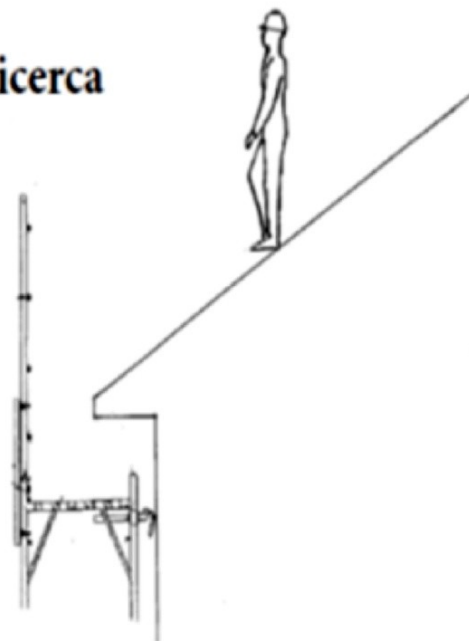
Parapetto di sommità [Fab-015]
